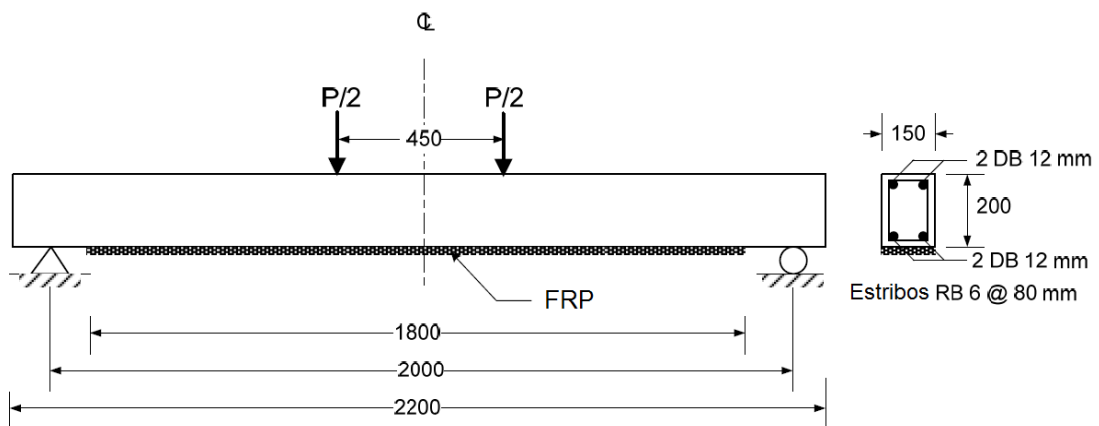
Dimensões em mm e detalhamento das vigas (Lenwari e Thepchatri, 2009)
